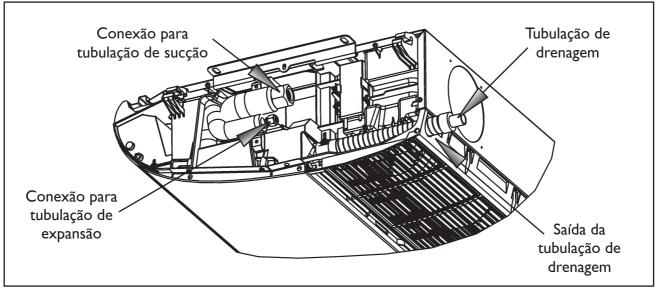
TUBULAÇÕES DE DRENO MONTAGEM TETO
